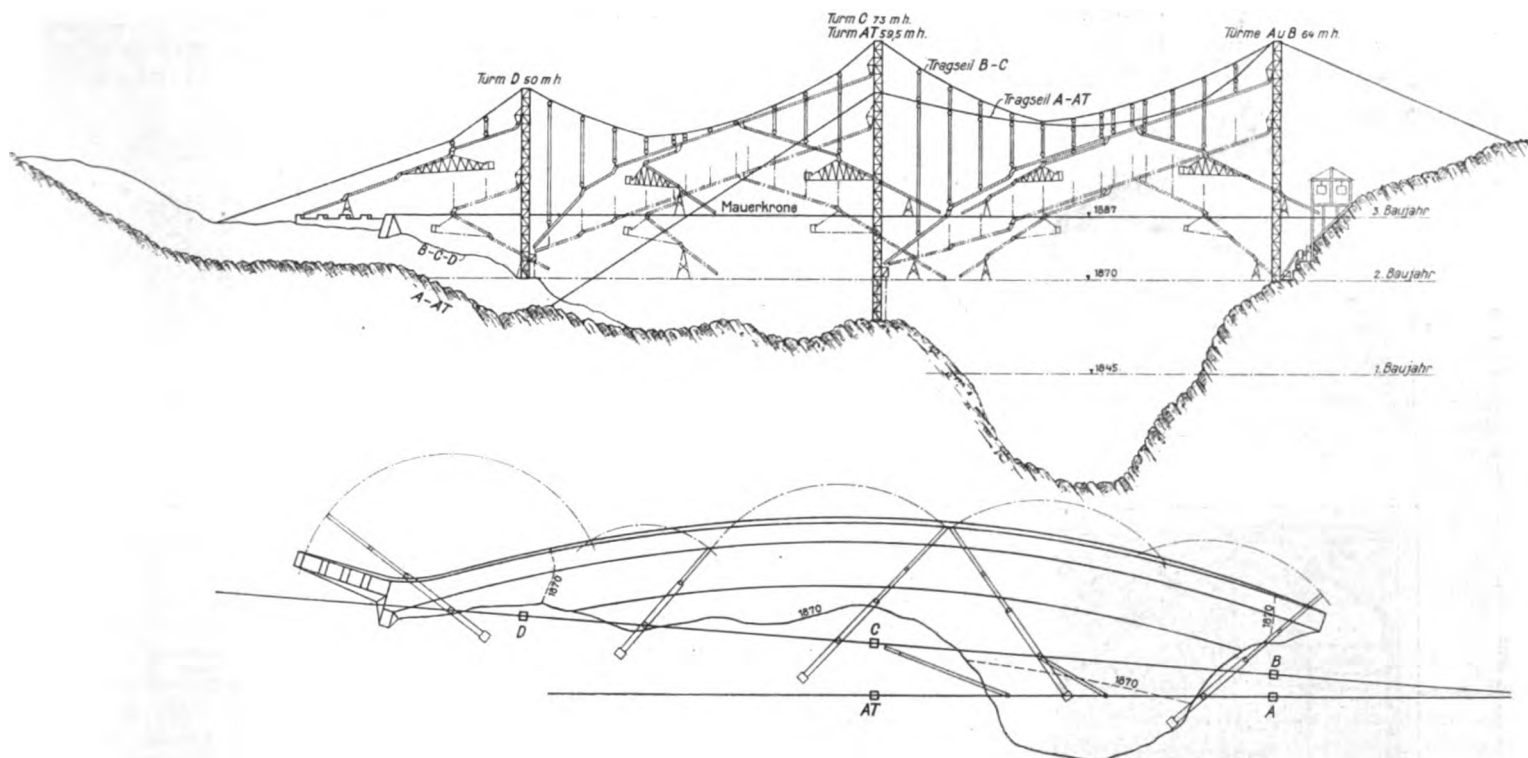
Grundriss und Ansicht im Vollausbau, für Betonierung bis auf Staumauerkrone auf 1887 m ü. M. — Masstab 1:2000.
